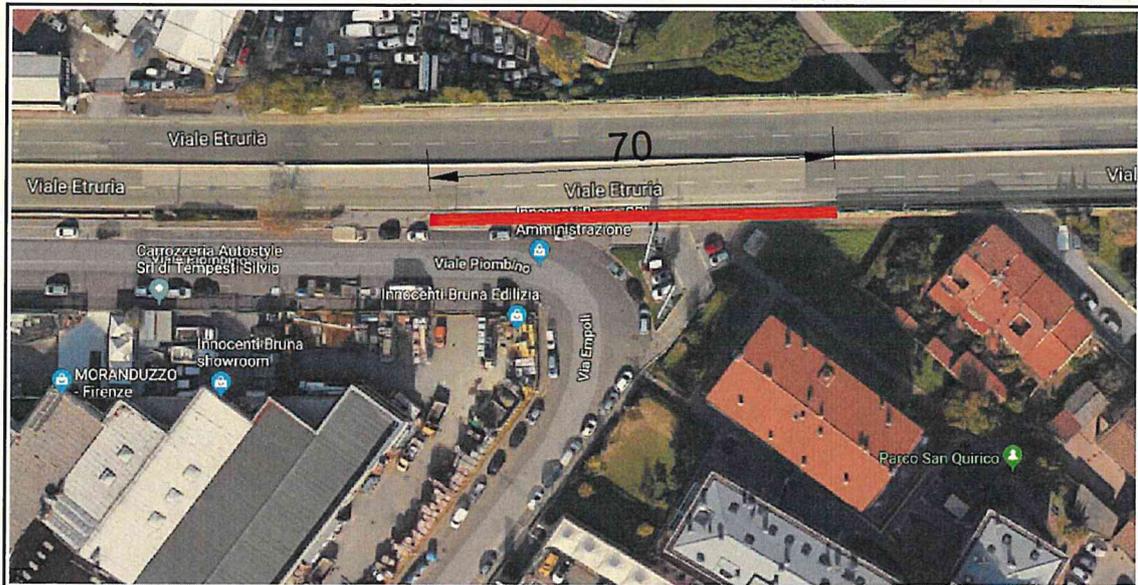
Individuazione del tratto di installazione della barriera.
